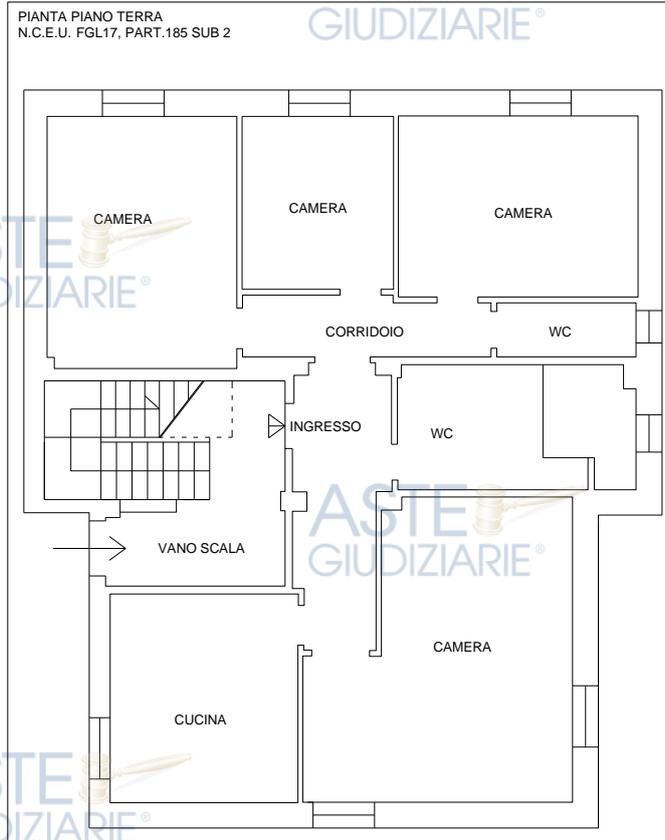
Pianta piano terra rilevata in sede di sopralluogo.
